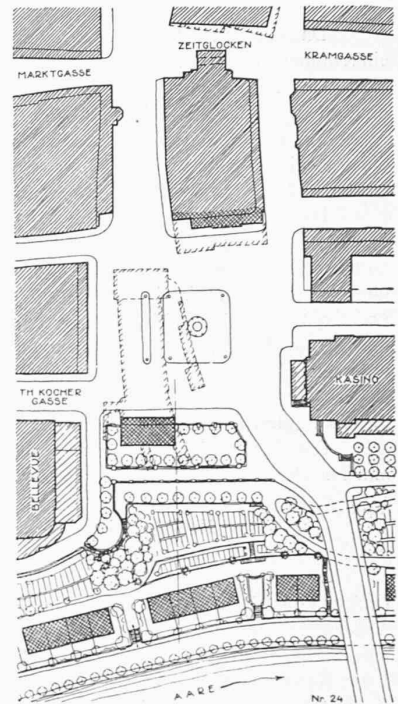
Lageplan 1 : 2500 zu Nr. 24.
